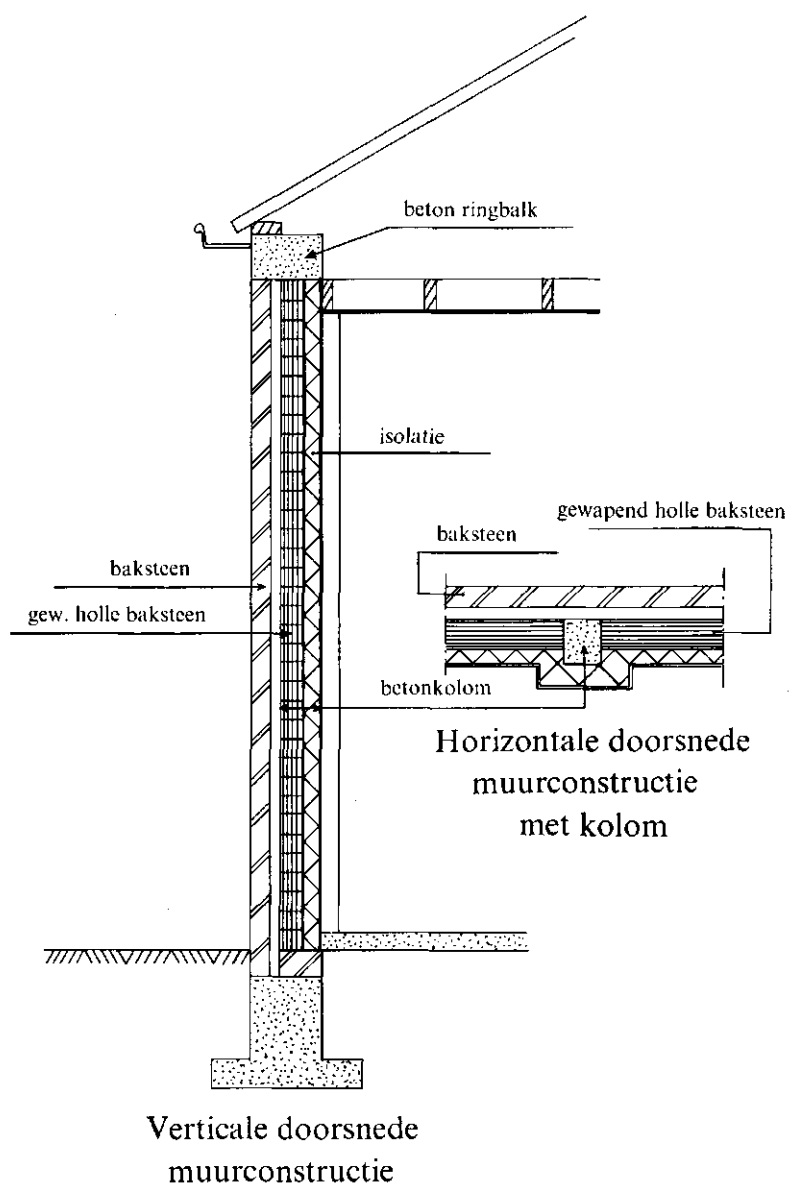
Wandconstructie bij een bewaarplaats voor losgestorte produkten.
